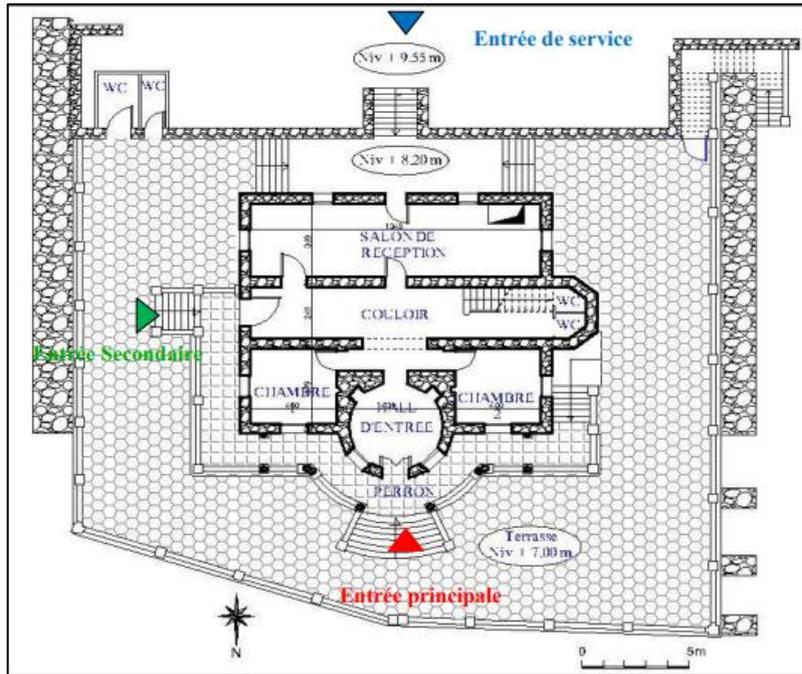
Plan RDC du Château Poizat. Source : Auteur.2023
